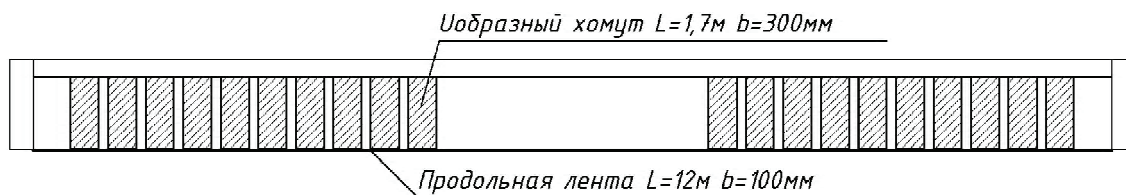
Общая схема усиленной конструкции углеволокном.
